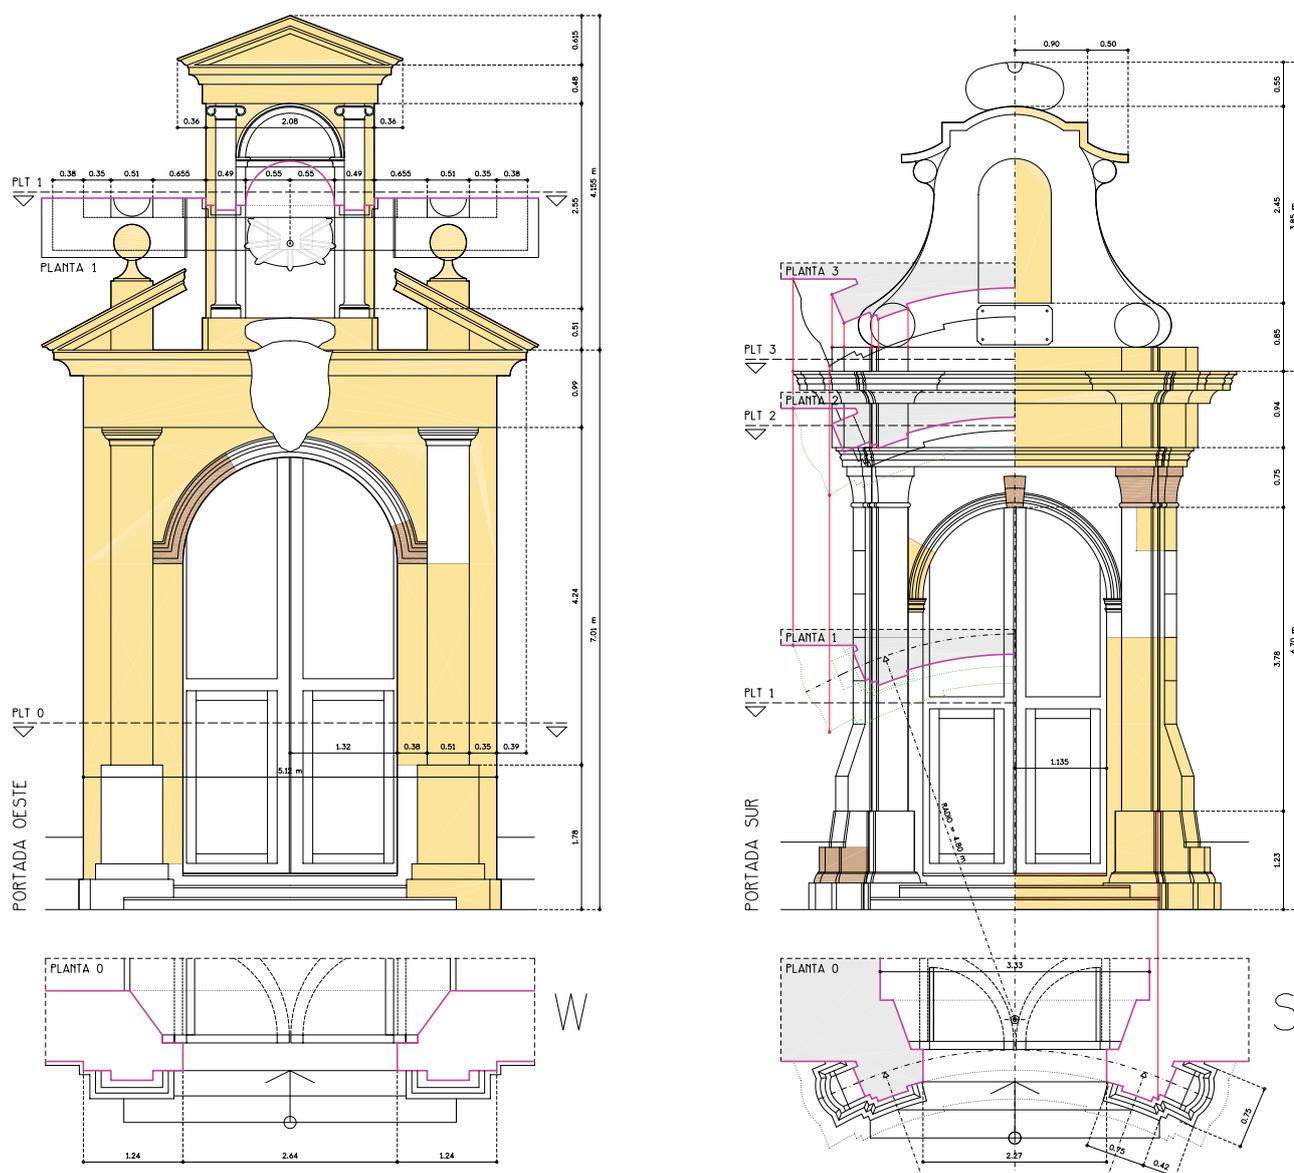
Proyecto de reconstrucción de las portadas sur y oeste (2008-12)
